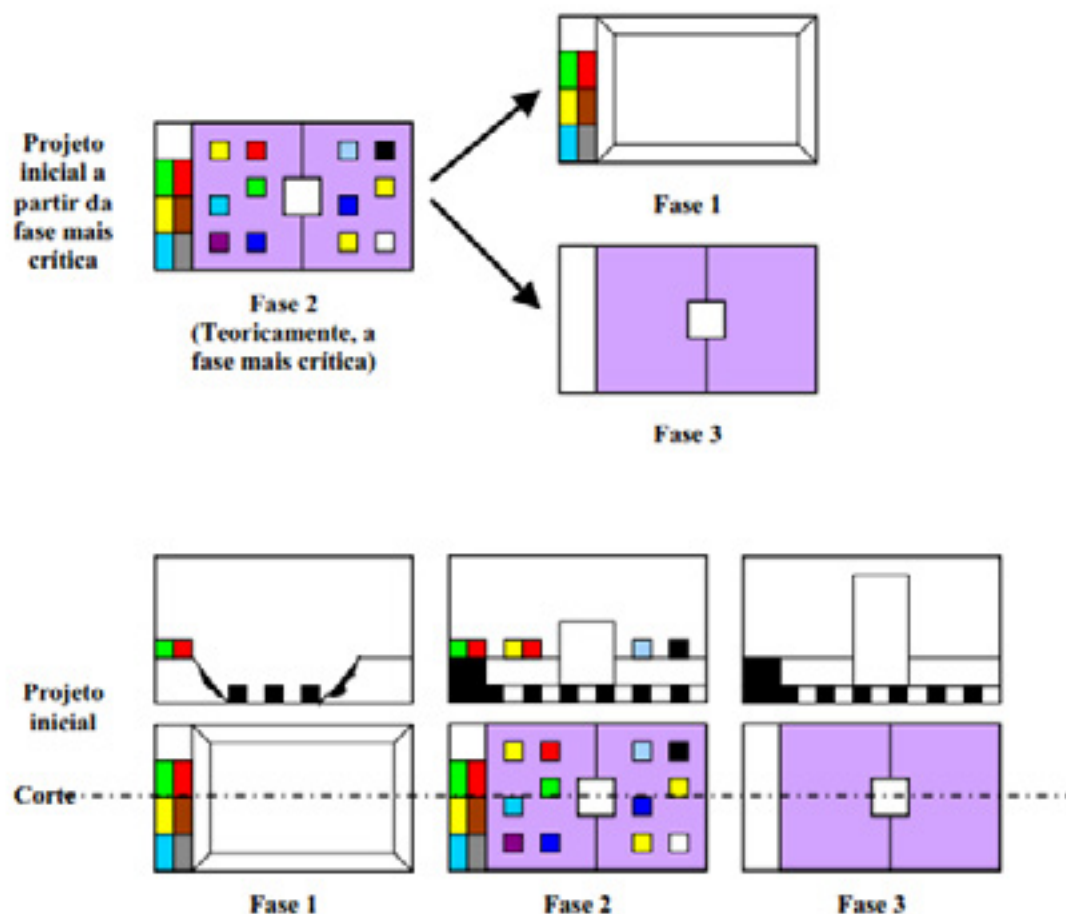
Esquema do dimensionamento e implantação do canteiro de obras
